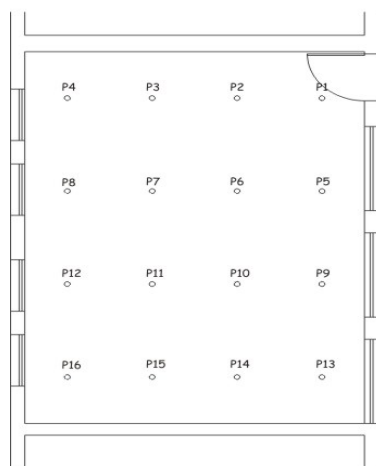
Planta baixa, com respectivas marcações de pontos.
